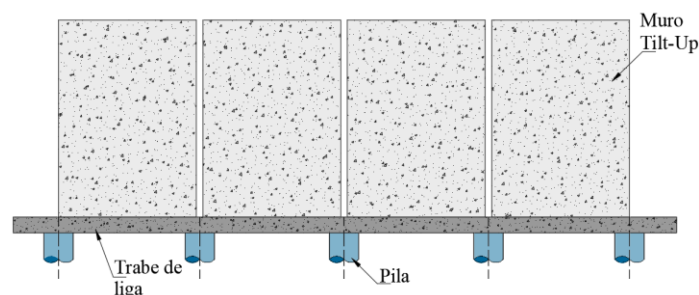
a - Arreglo de pilas para soporte de muros
